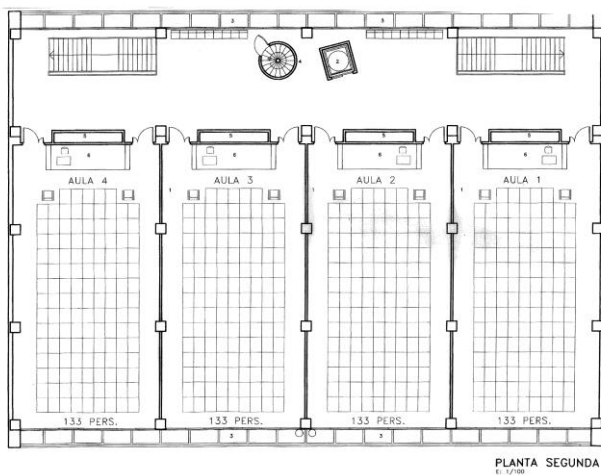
Imagen aulario ingeniería de la edificación y arquitectura
